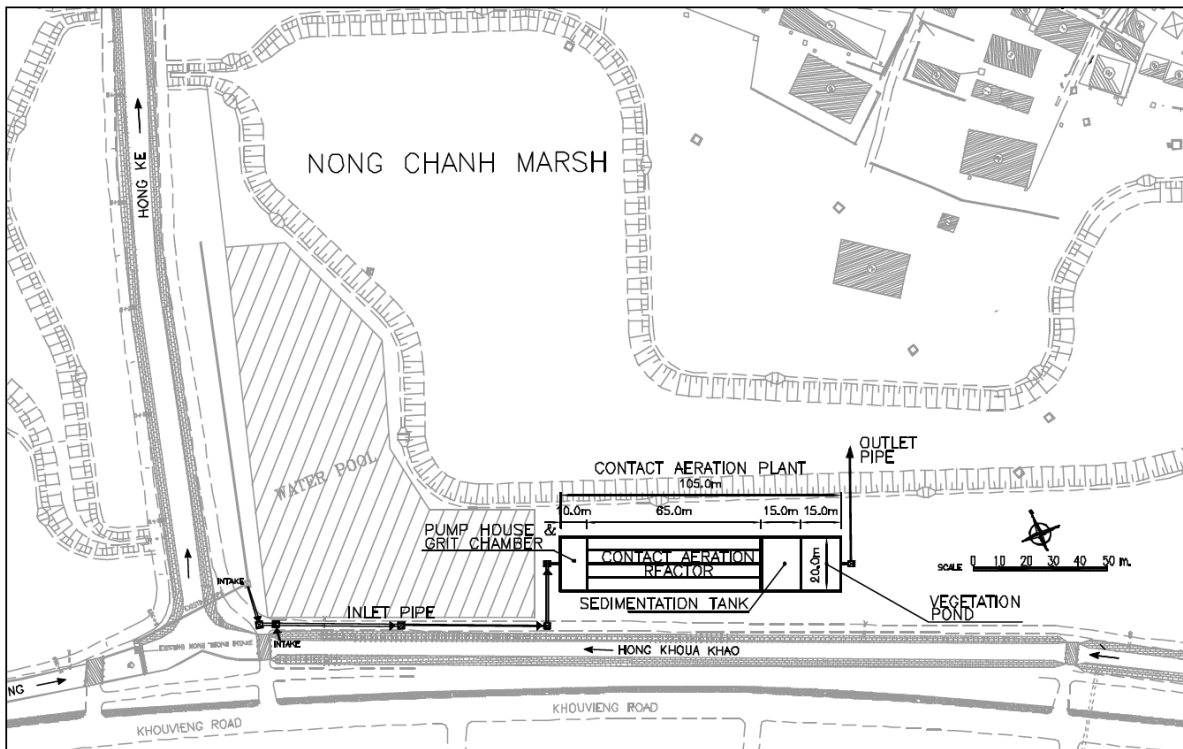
Nong Chanh 湿地における接触酸化型水路浄化施設の平面図
